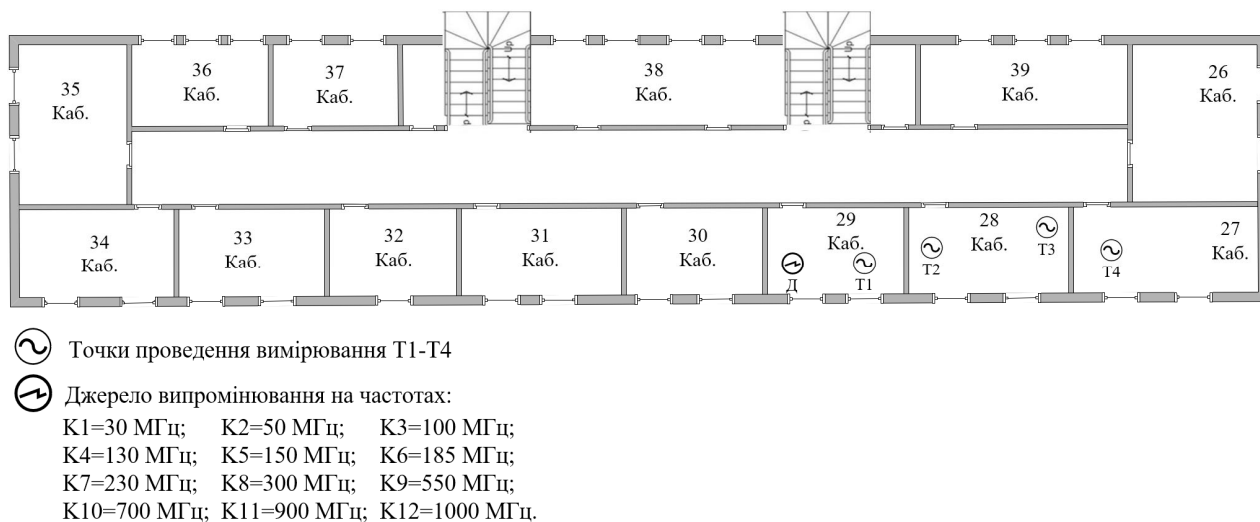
План будівлі де проводились вимірювання (другий поверх)
